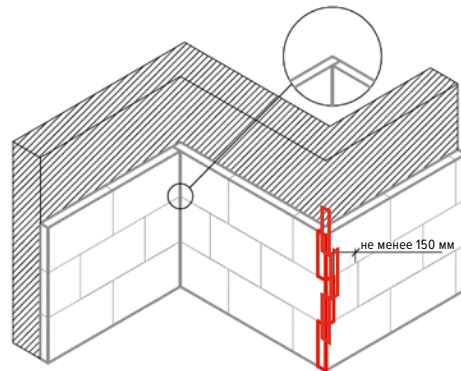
Схема перевязки плит на внутренних и наружных углах здания
